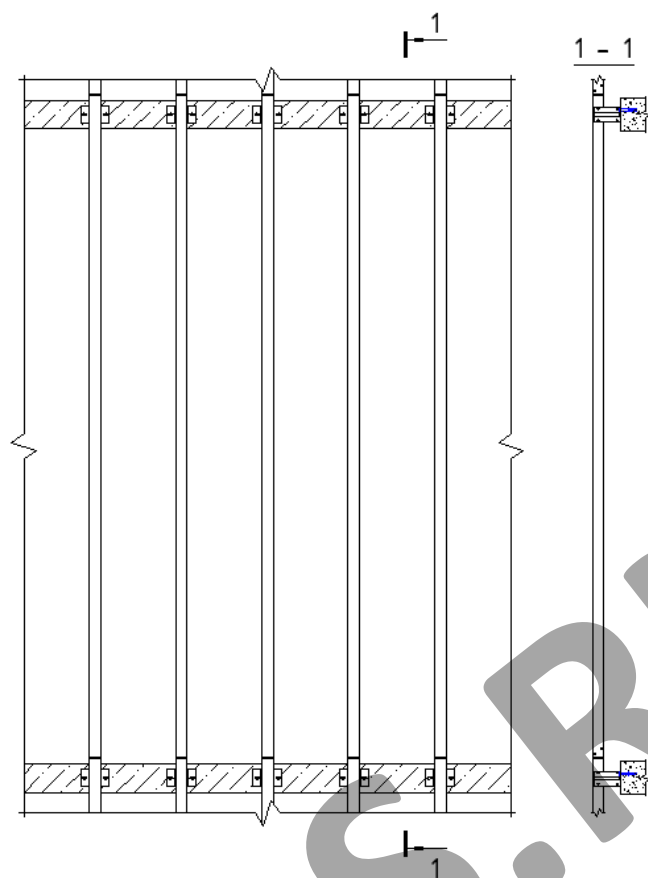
Система крепления в межэтажные перекрытия на основе кронштейна КНс-28/1 и профиля ПК/1
